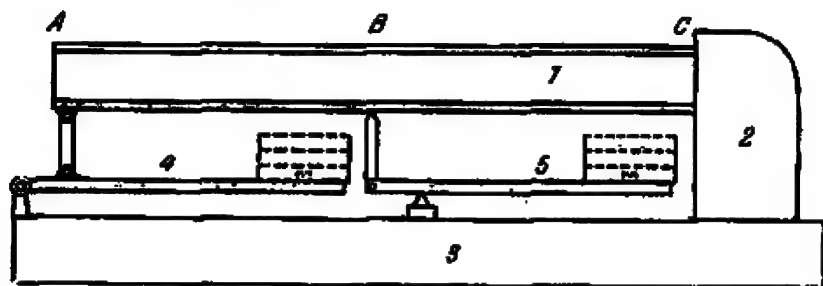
| Instalación de mesa para el ensayo de la viga a flexión: 1, viga de doble T ensayada; 2, viga maciza; 3, bancada; 4 y 5, palancas para cargar la viga.
